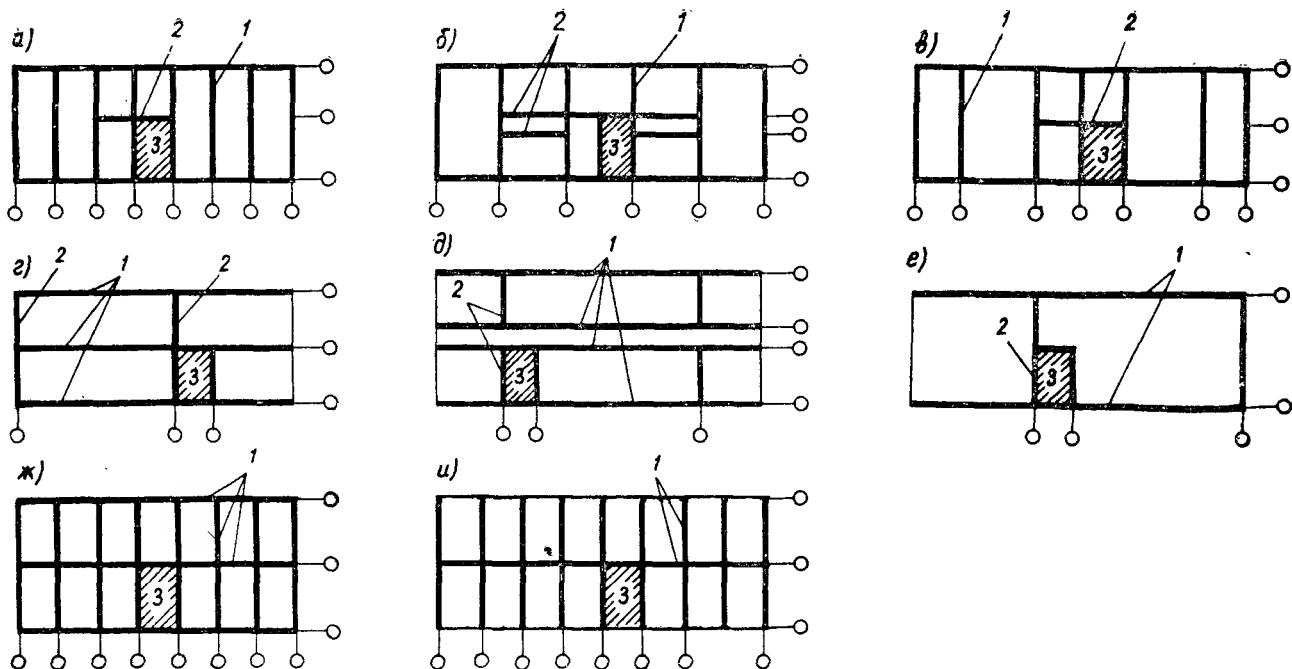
Конструктивные схемы зданий с несущими стенами
